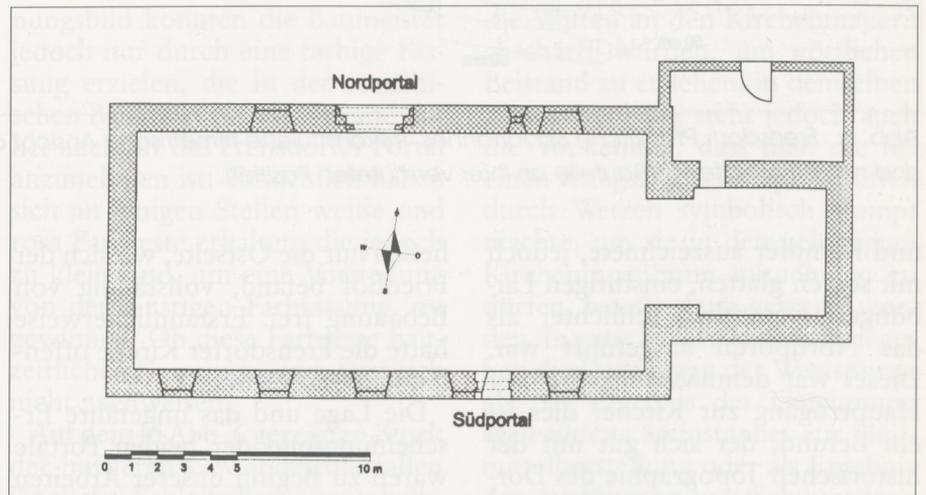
Frensdorf, Pfarrkirche St. Johannes. Grundriss der Kirche vor dem Umbau. 1980 kamen beim Abbruch der Langhauswände die romanischen Portalfragmente zutage.
